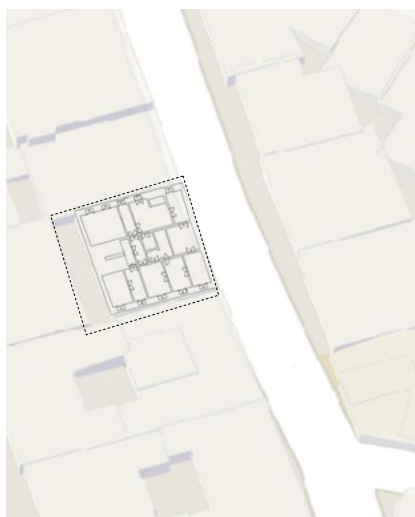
Vista em planta sem escala, de avenida e rua com planta de apartamento sobreposto em espaço do edifício, criação do autor.
